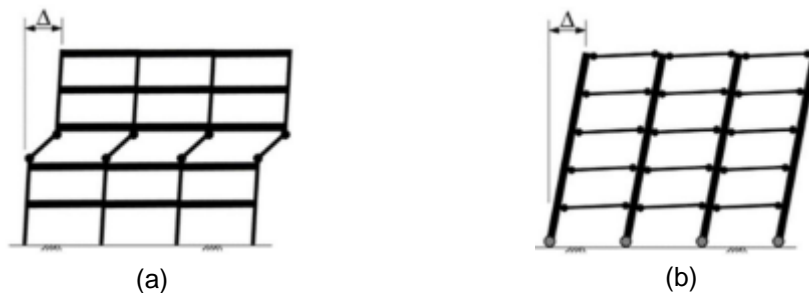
Mecanismos: (a) Piso blando, (b) Columna fuerte – Viga débil. [37]
